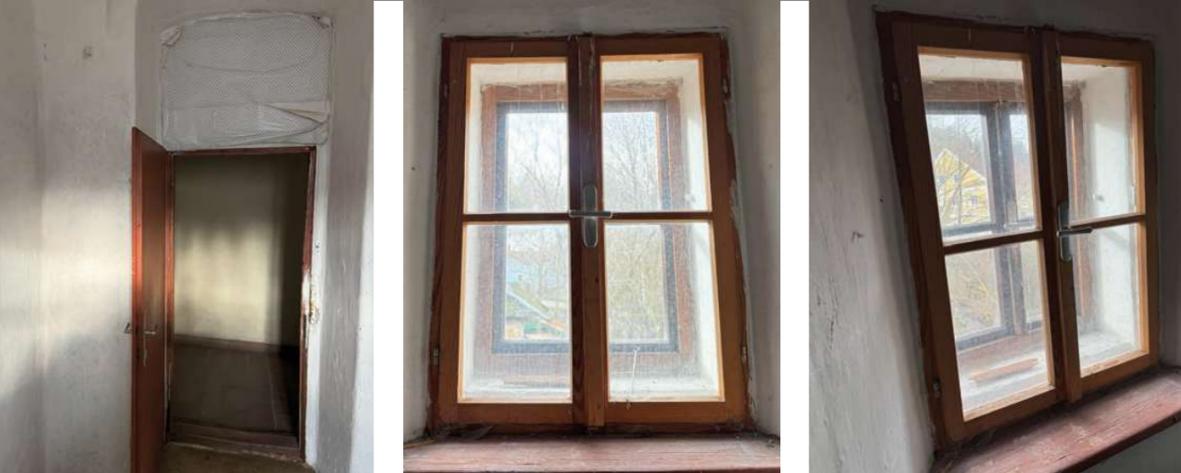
R1.09-07 (D1): Detail Eingangstüre, innen, offen
